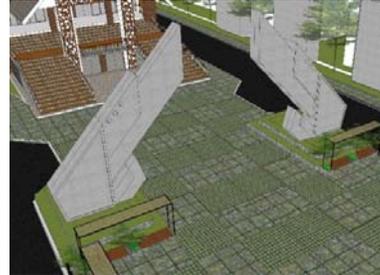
Fasad Bangunan (sumber hasil Perancangan)
